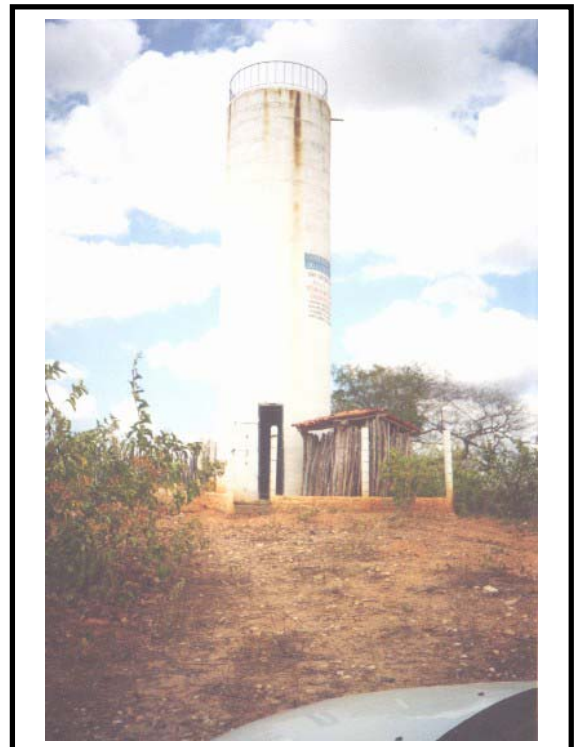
VISTA DO RESERVATÓRIO ELEVADO PARA ABASTECIMENTO DE AURORA
